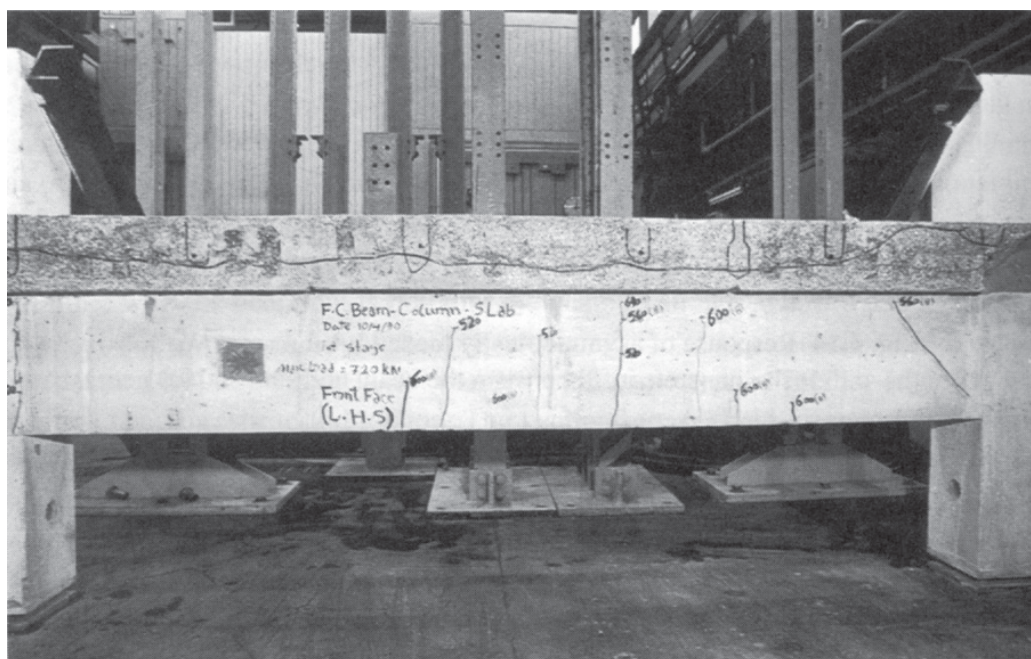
Padrão de fissuração em viga de seção “L” com solidarização com a laje alveolar [ELLIOTT; JOLLY, 2013].
